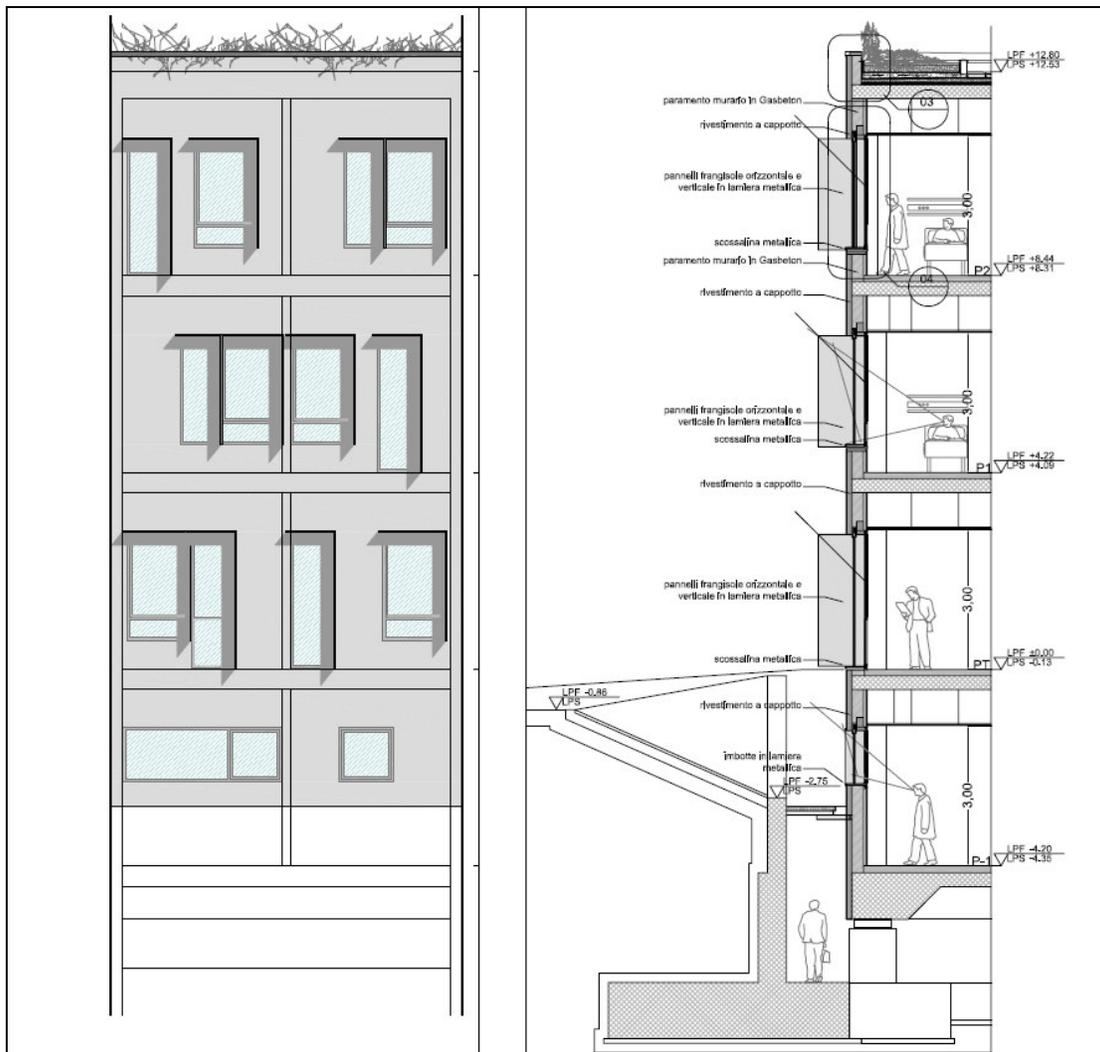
Sezione facciata a cappotto (tavola AR-27)
